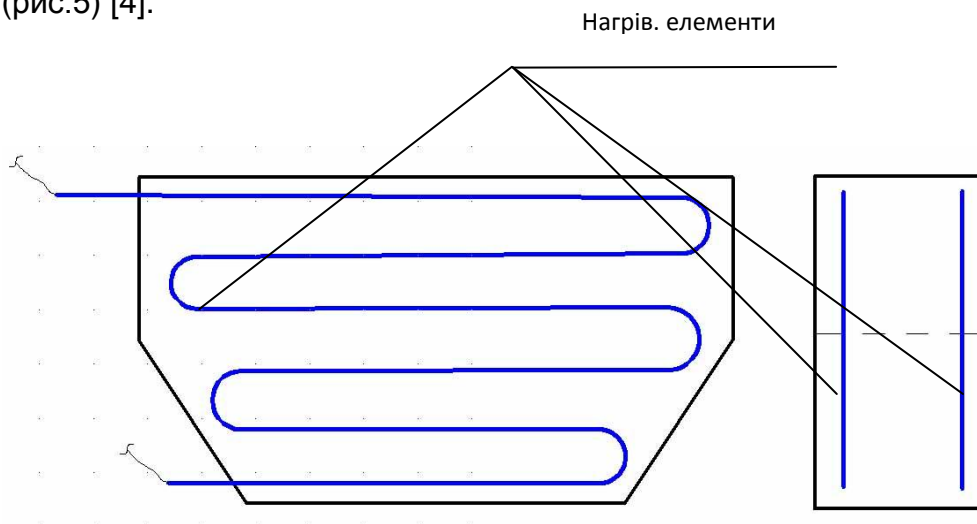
Влаштування електрообігріву бетону при зимовому бетонування
